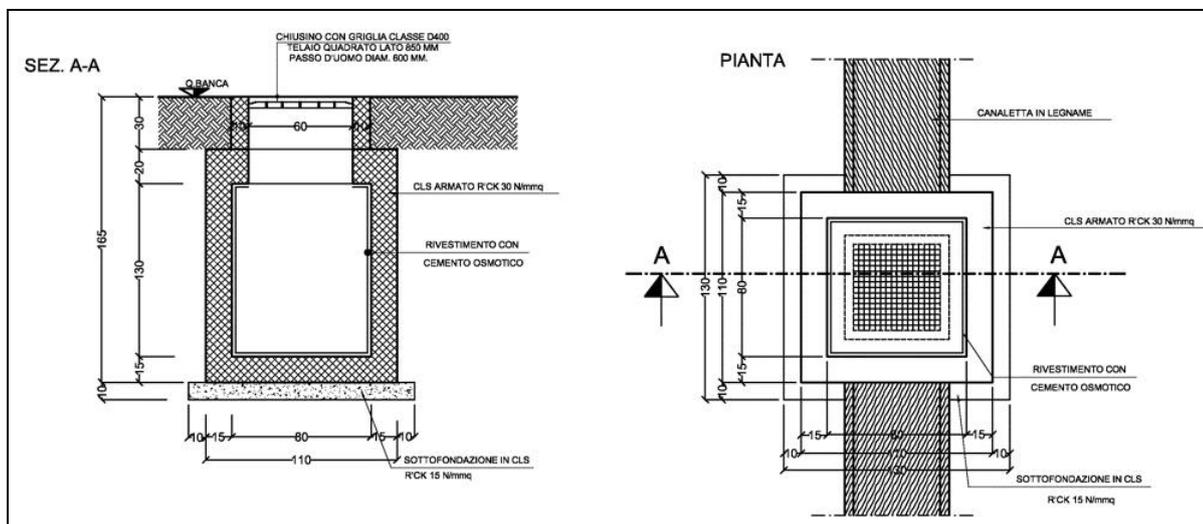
Compiuvio centrale – Pozzetto di decantazione in c.a. prefabbricato
